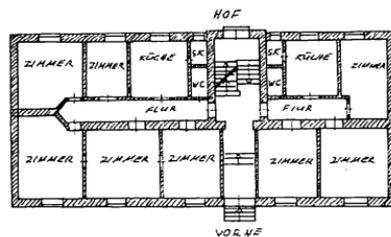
Grundriss einer Etage eines gründerzeitlichen Zweispanners
